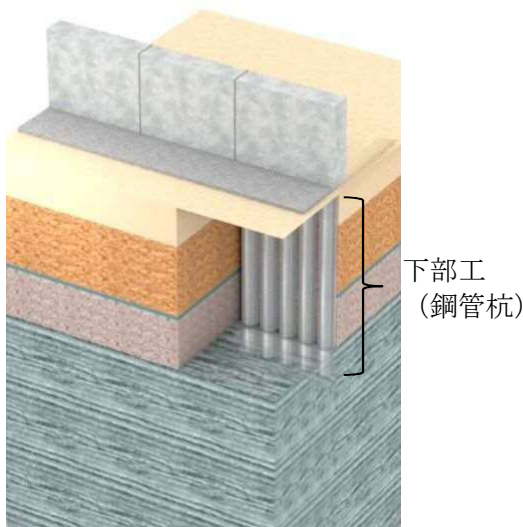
鋼管杭鉄筋コンクリート防潮壁の下部工
